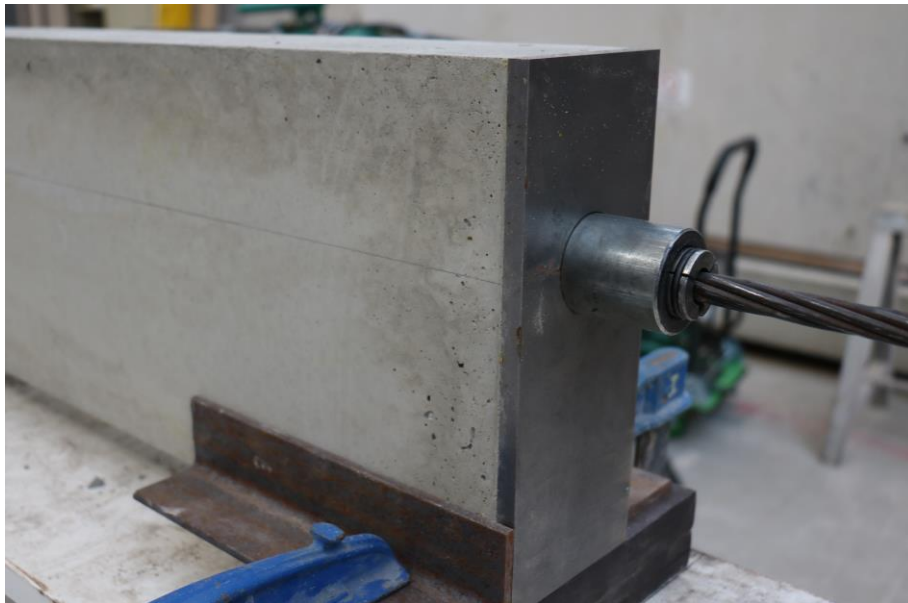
Estado de la viga tras acañar la viga, vista del anclaje activo. (Fuente: Elaboración propia)
